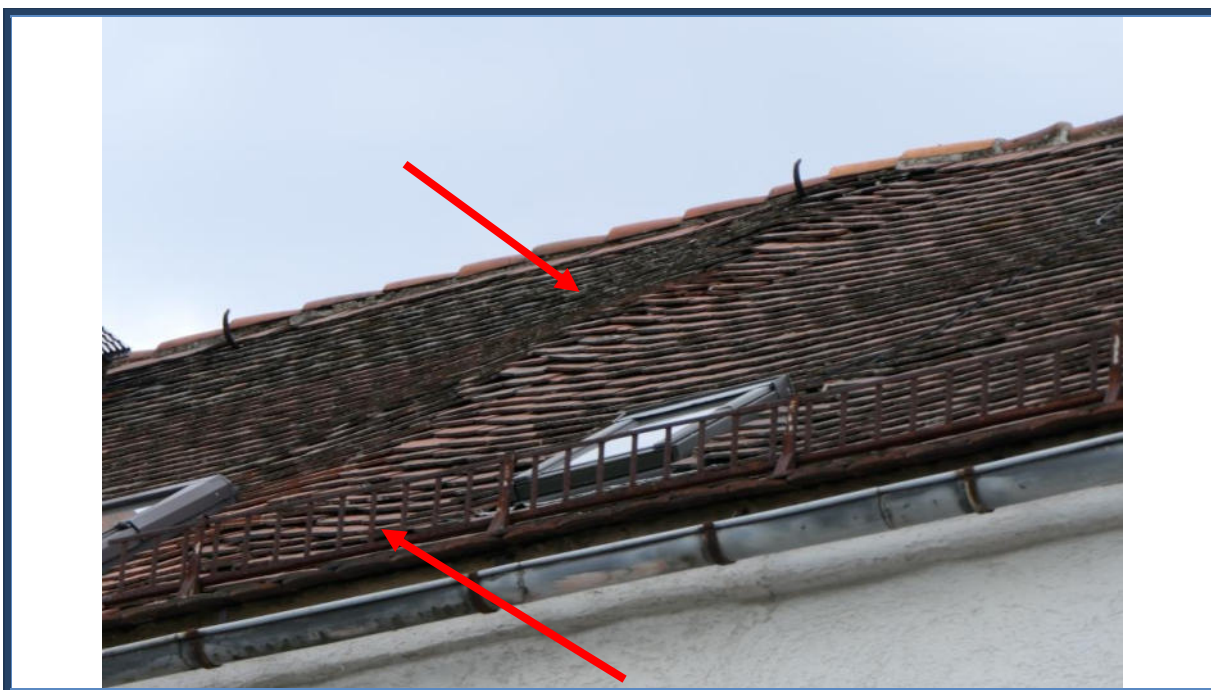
Vordergebäude: Detailansicht (Dachkonstruktion uneben)
